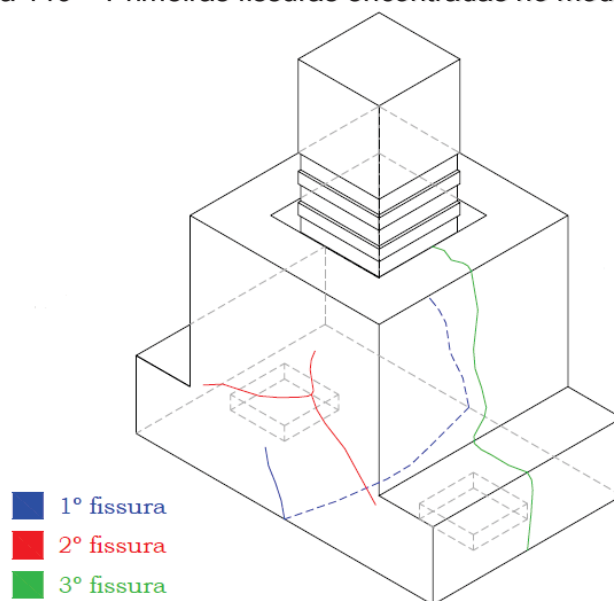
Fissuras no modelo experimental para carga de ruptura
